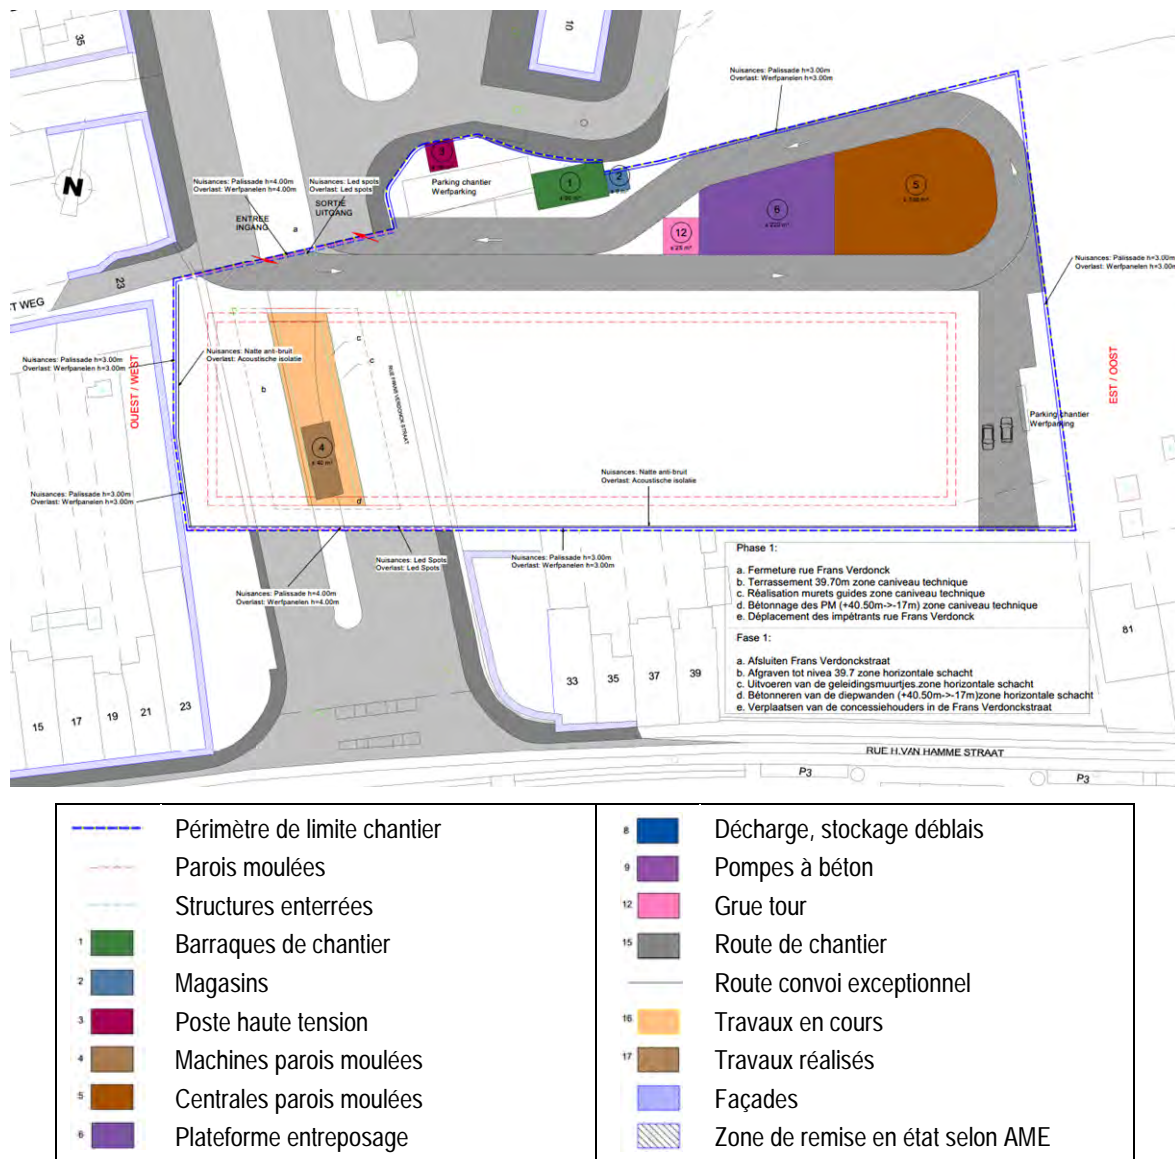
Plan de la phase A des installations de chantier (BMN, 2019)
